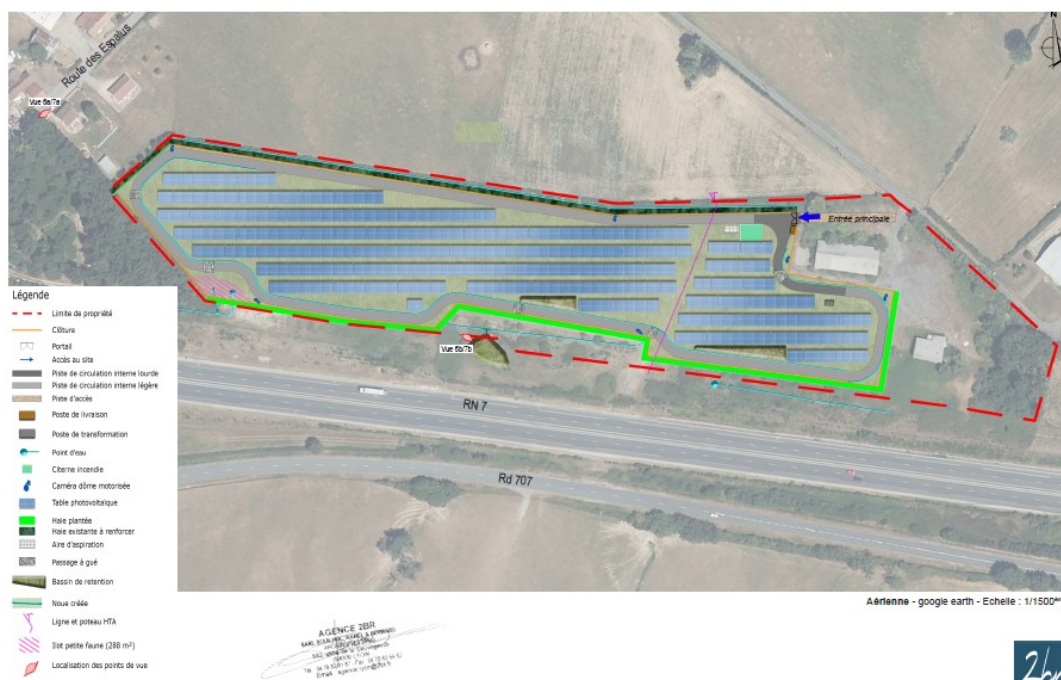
plan de masse des installations (source dossier Permis de construire)
